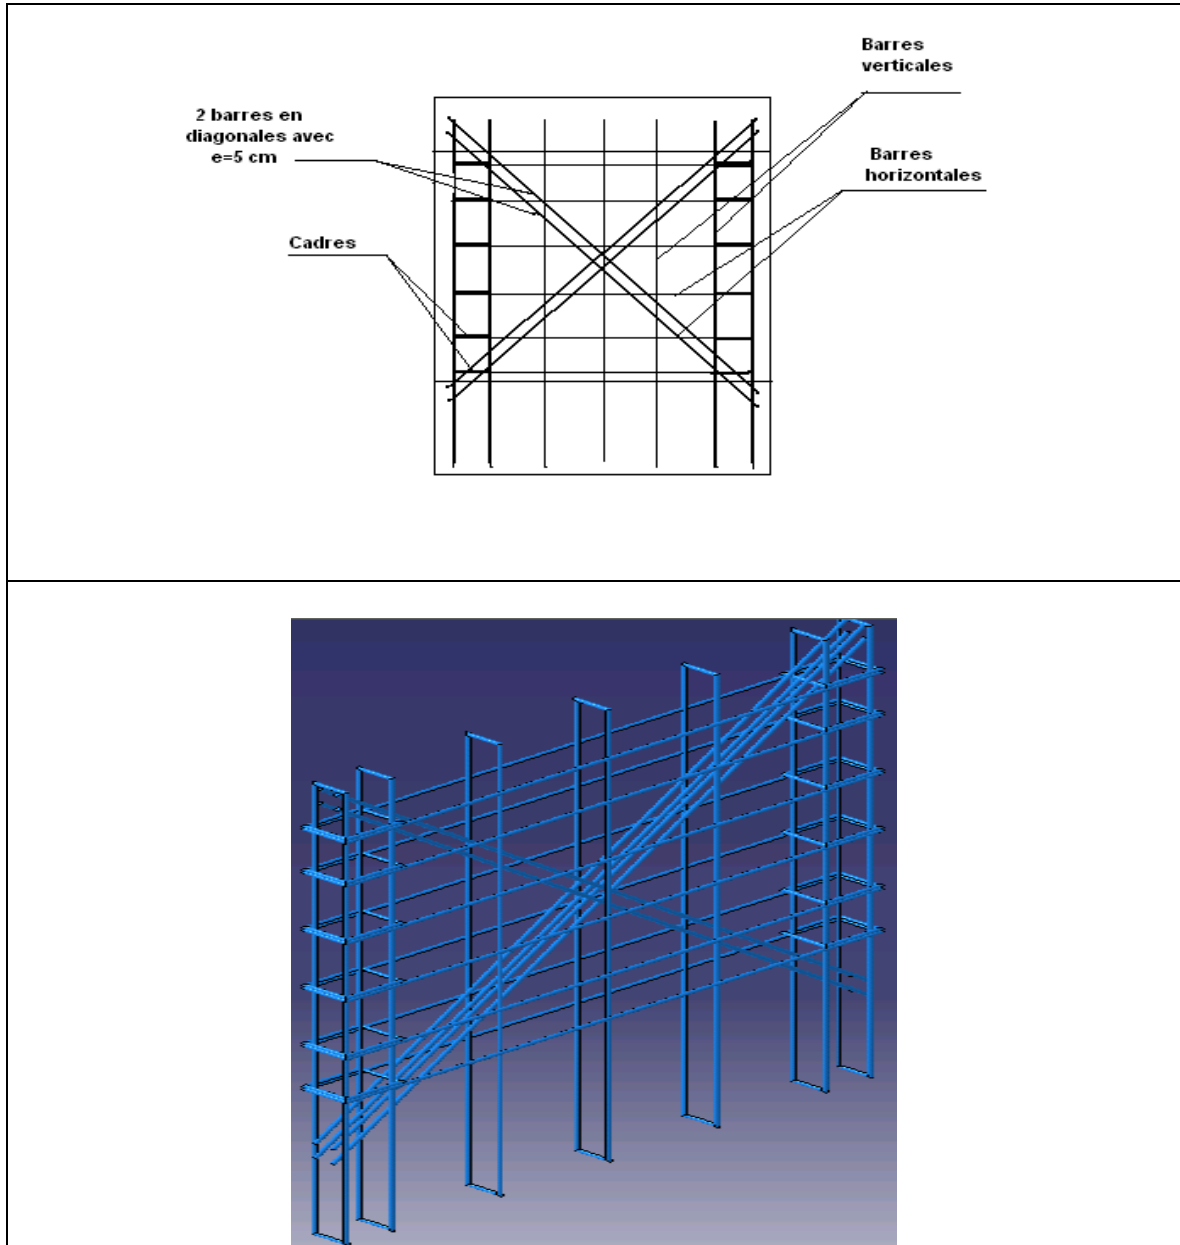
Ferrailage du voile renforcé à 8 barres.
